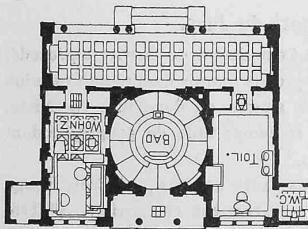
Grundriss vom Badehaus der Läuger-Gärten. — 1:400.
